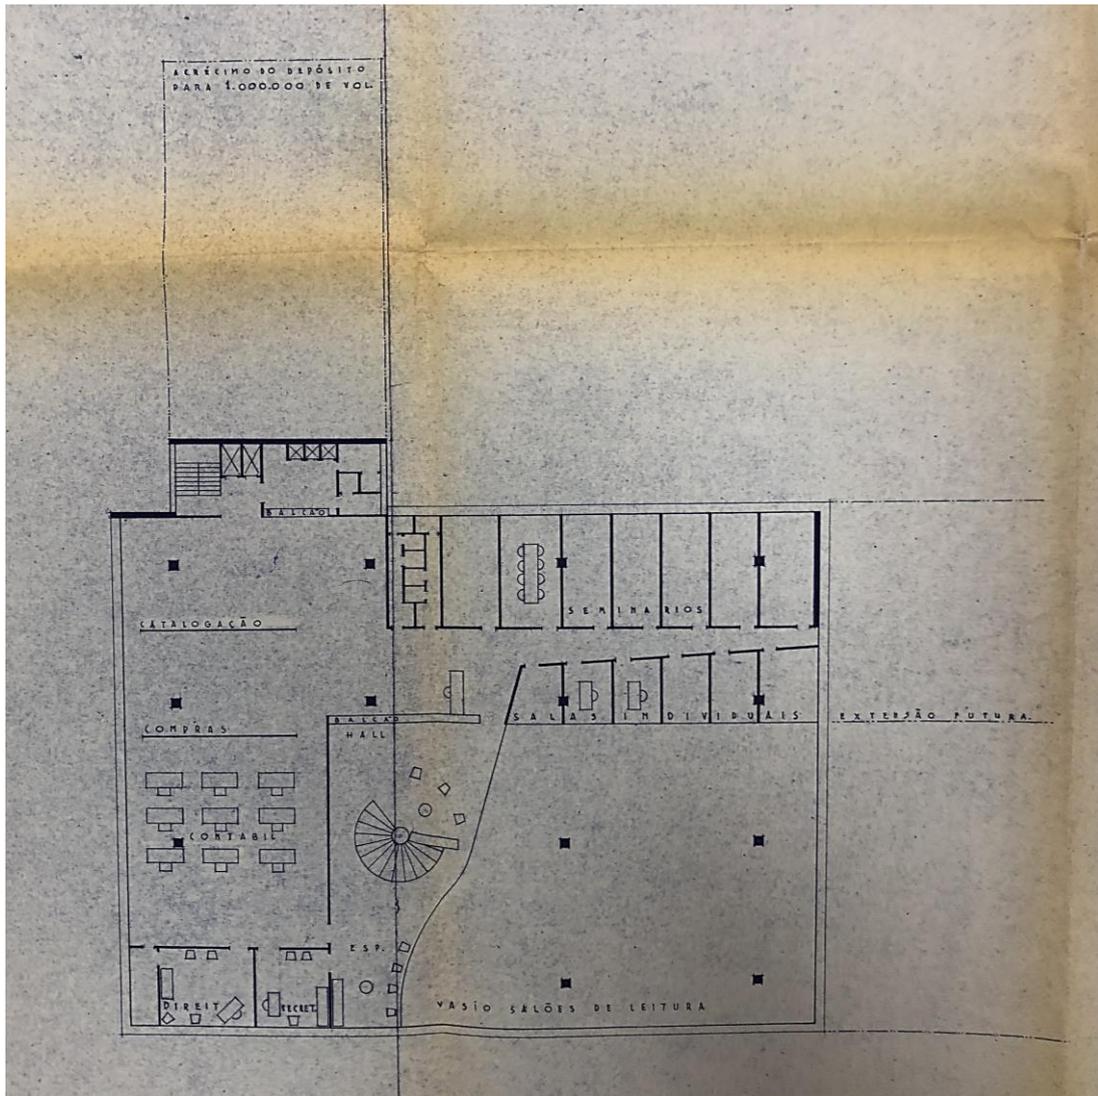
Planta do 3º pavimento da Biblioteca Central do Centro Cívico. Fonte: Arquivo FAU USP.
